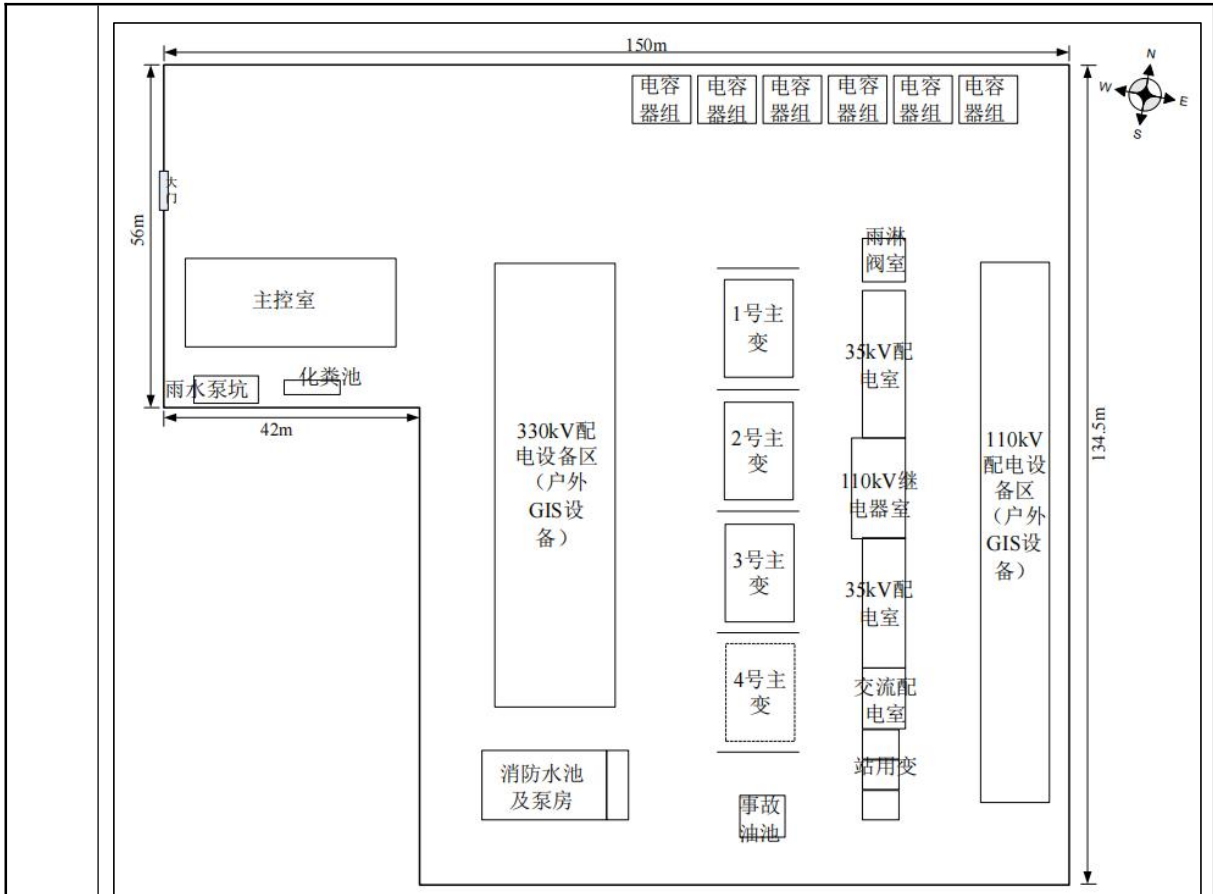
大唐蒲城 330kV 汇集站平面布置示意图
